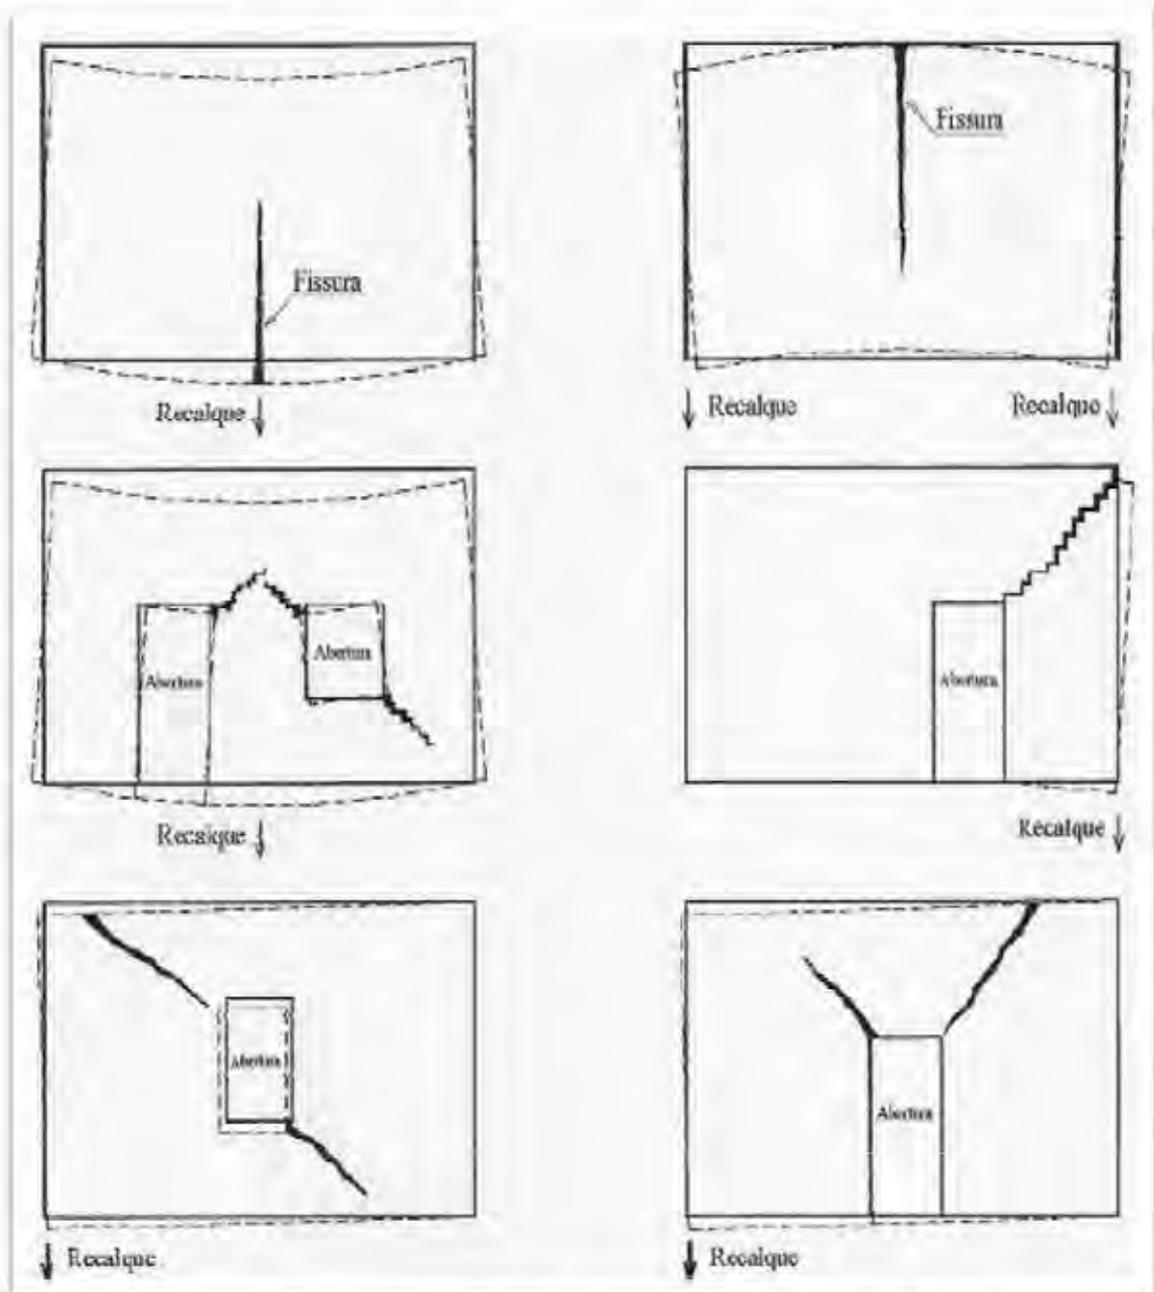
Fissuras causadas por recalques diferenciais da fundação. Fonte: <http://www.google.com.br/imglp?hl=pt-BR&tab=wi>
